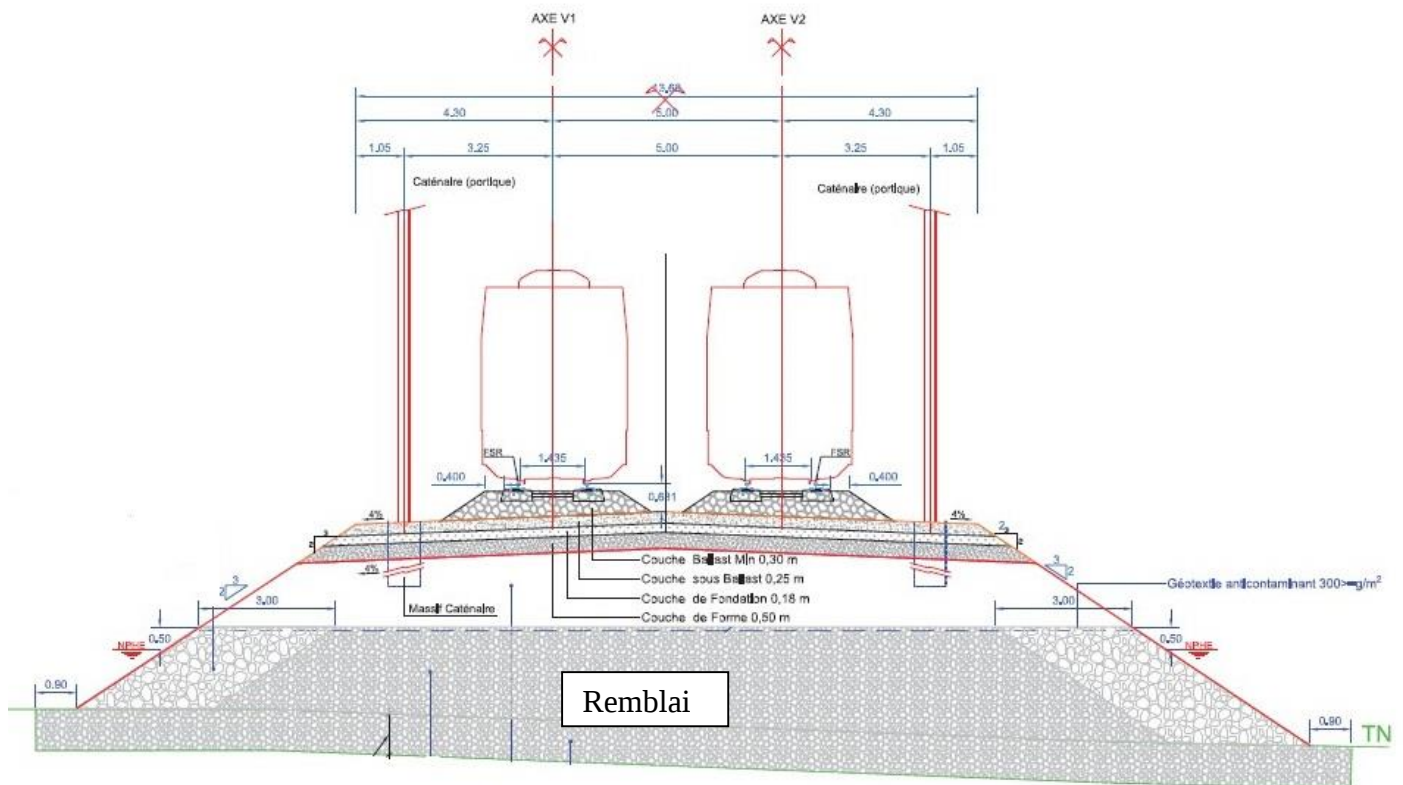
Profil en travers type d'une voie ferrée à double ligne.
